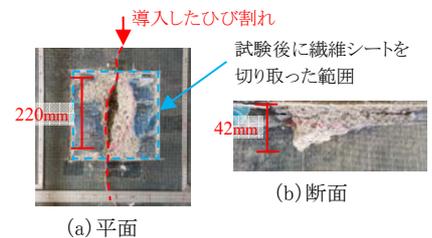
コンクリートの破壊状況 (ケース3-1 ①)
